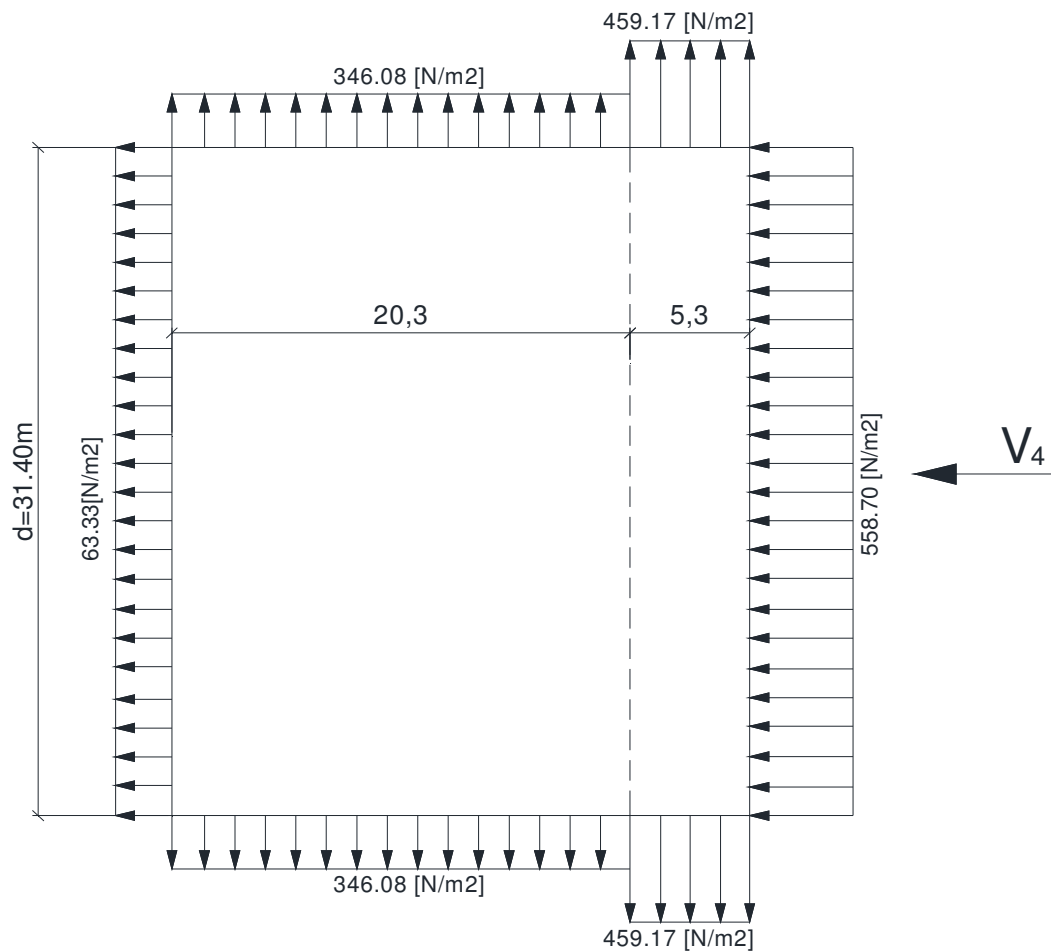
Pression du Vent – Parois verticales –Long-pan façade Ouest
